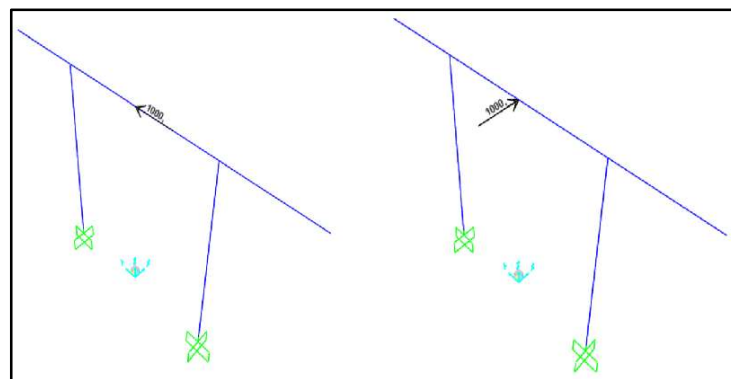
Modelo SAP 2000 Pórtico de las pilas.
